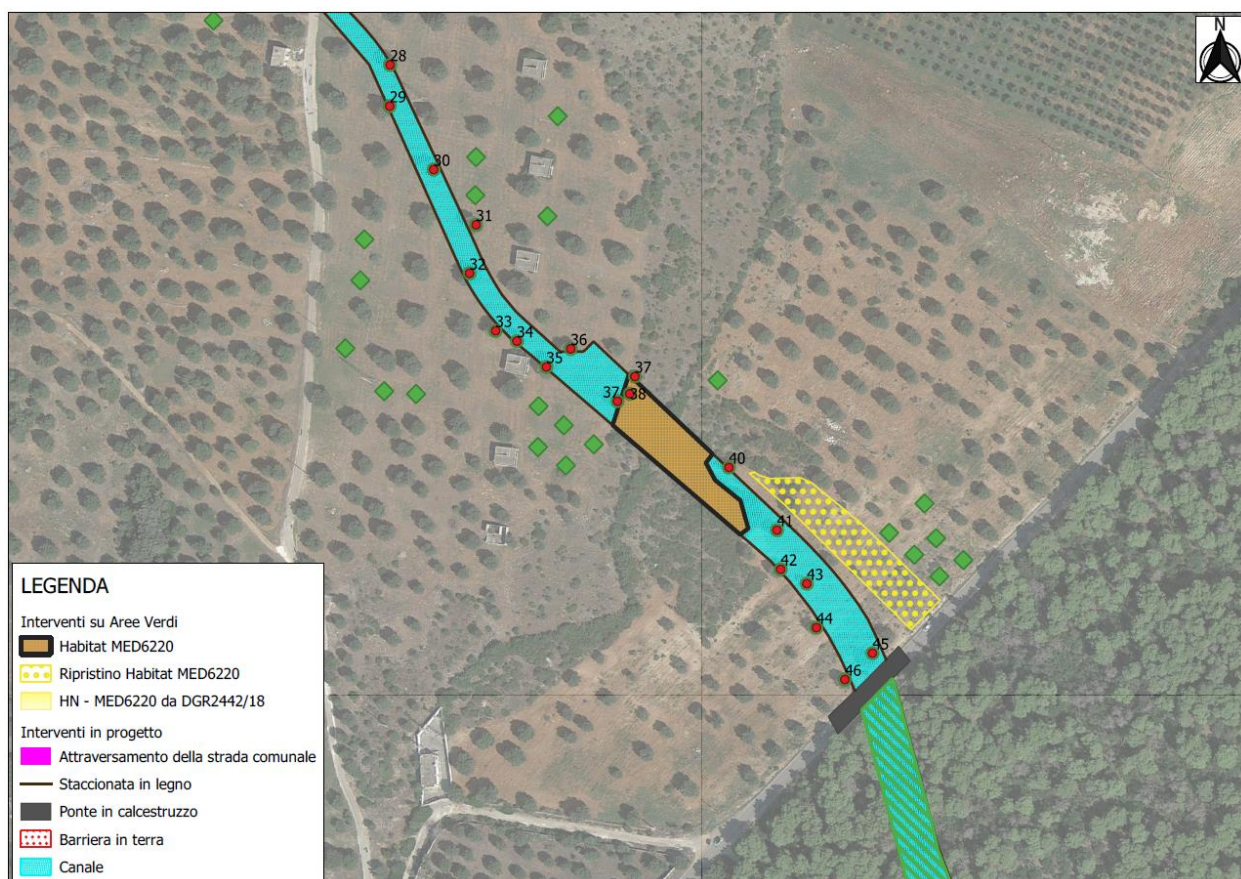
Planimetria con indicazione dell'HN-MED6220 interferente e dell'area di reimpianto
